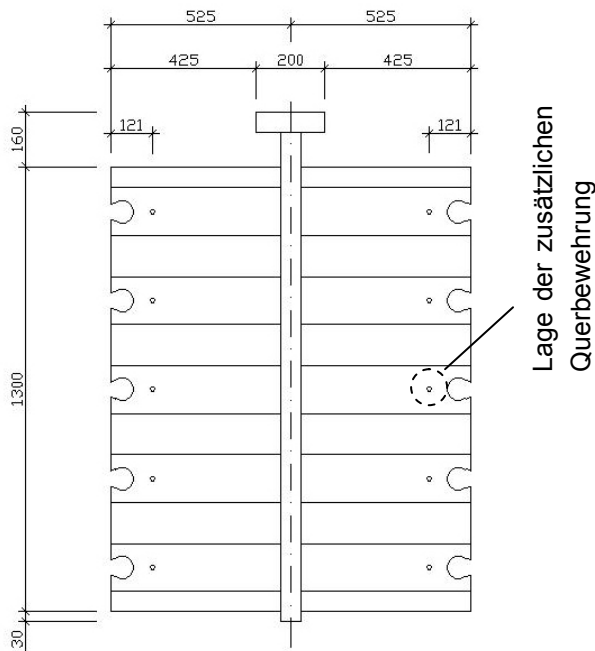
Stahlbauplan des Versuchskörpers BD3
